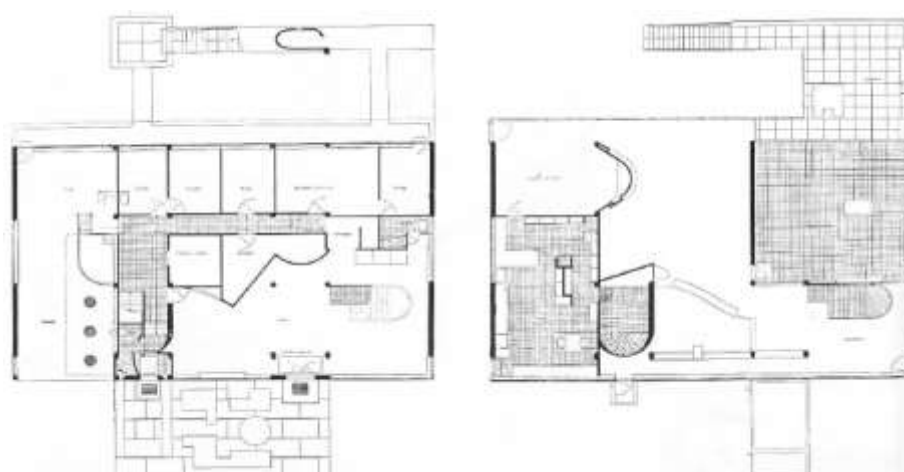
Planta do térreo e primeiro andar da Villa Stein em Garche
